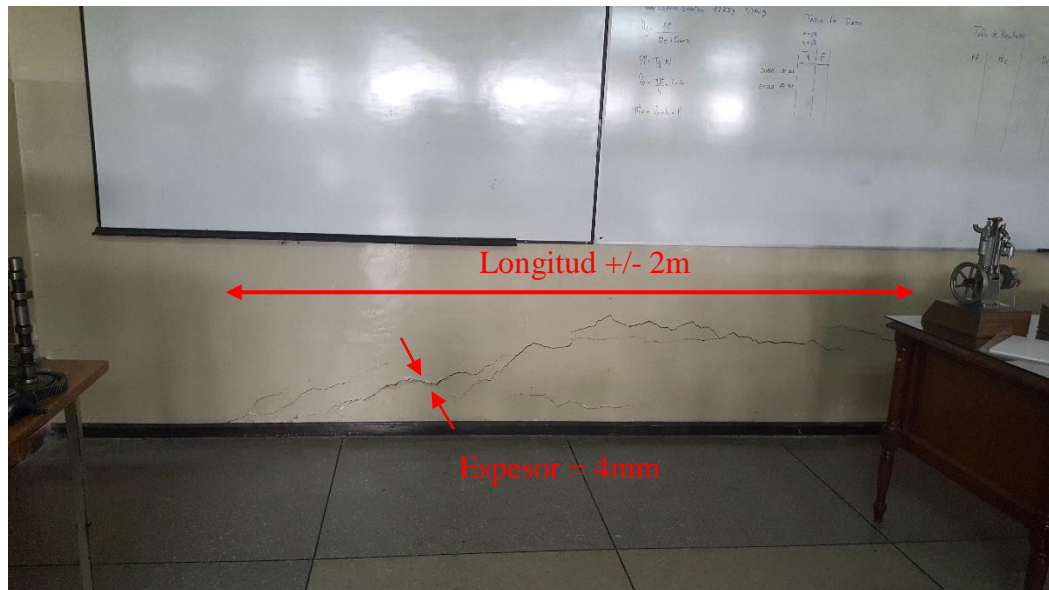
Grieta en mampostería, Planta baja eje D entre 2 y 3
